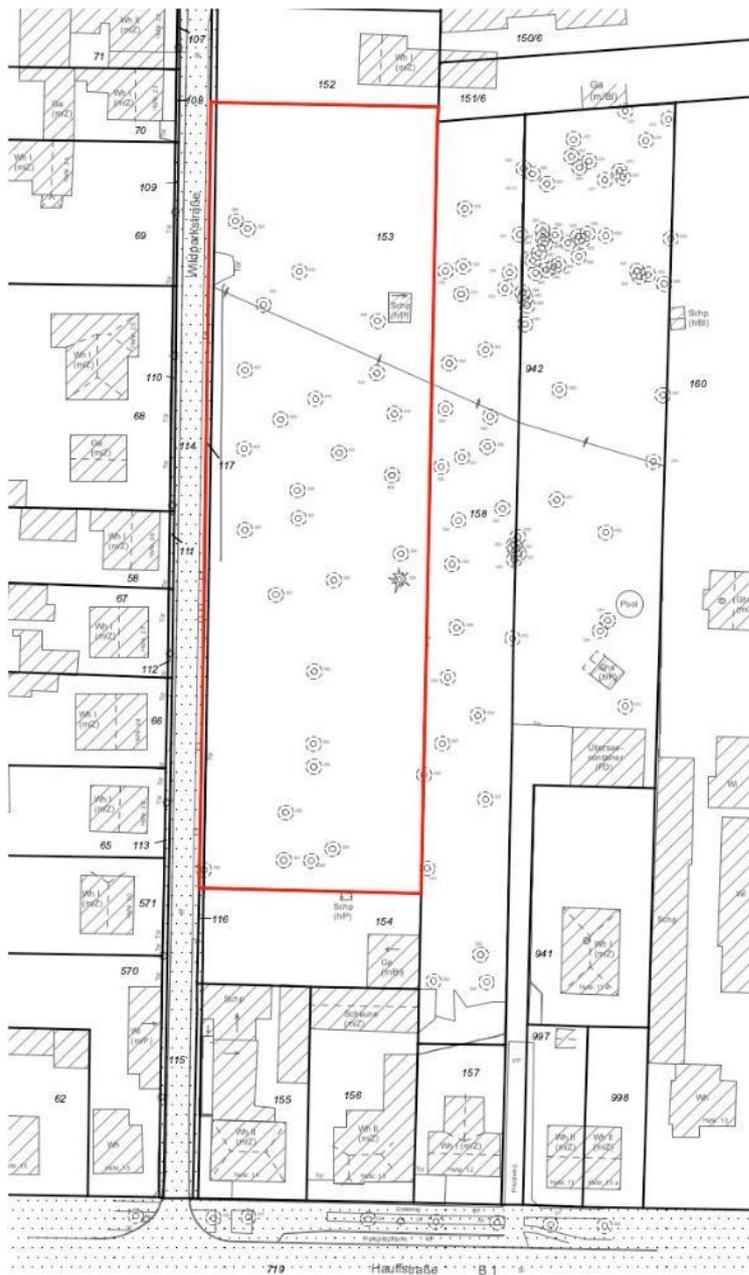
Geltungsbereich (Bestandslageplan, (c) 2022 Marten Kirchner)
